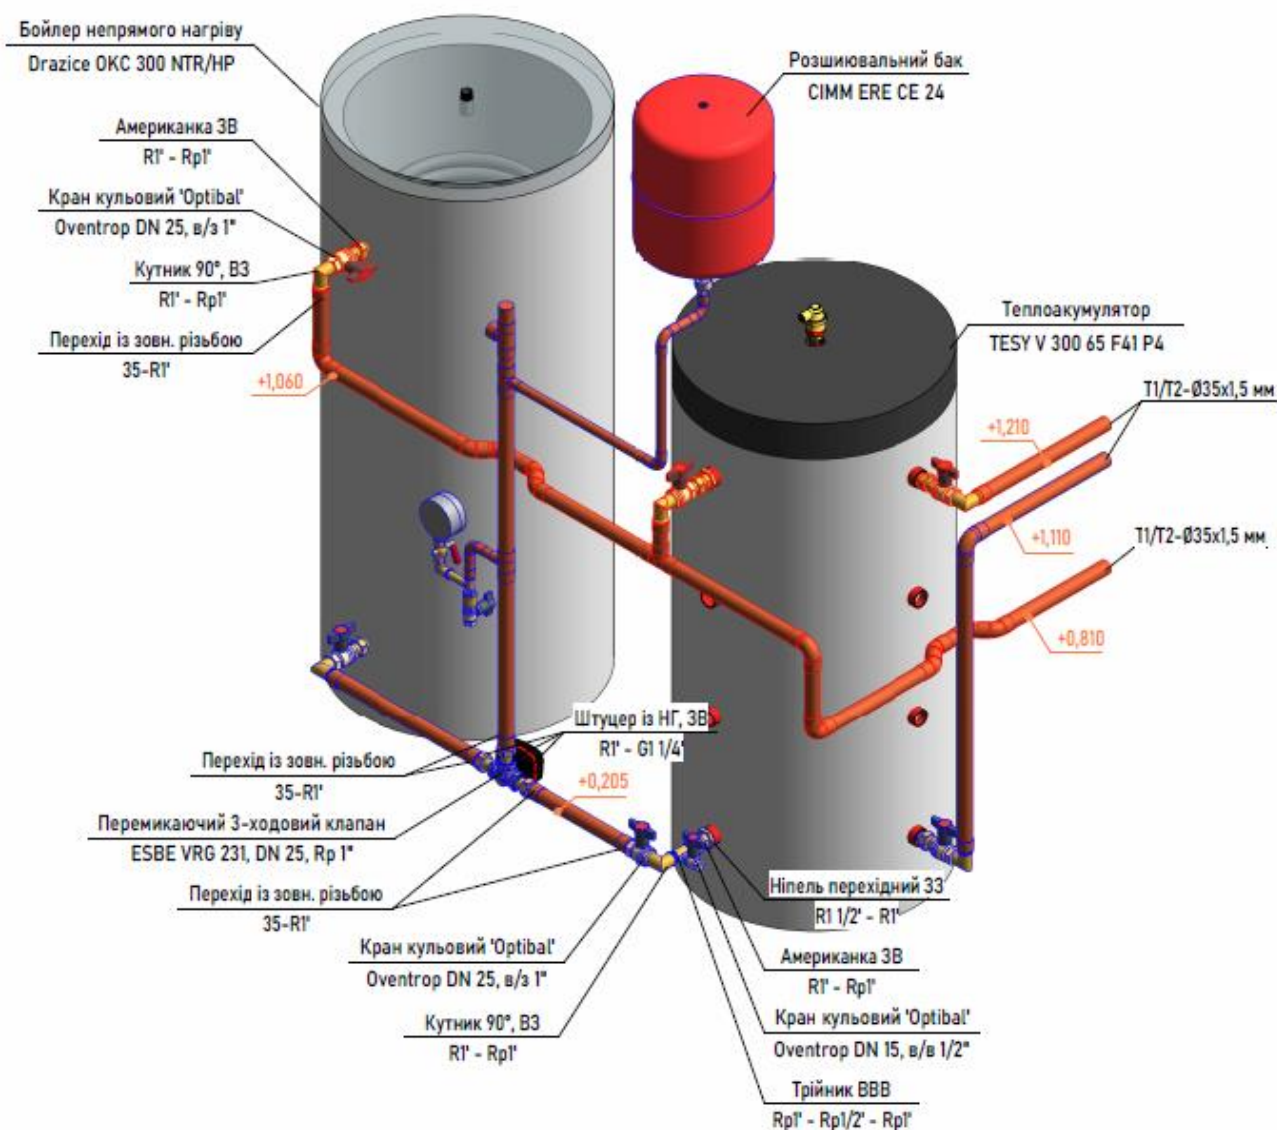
3D вид обв'язки бойлера і буфера
